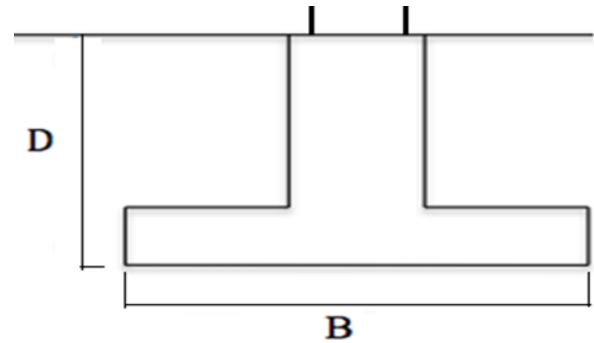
Схема розподільчого (поверхневого) фундаменту
